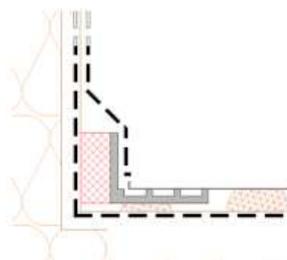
esempio di raccordo del davanzale alla spalletta con due superfici drenanti (lo strato 1 corrisponde al davanzale stesso, lo strato 2 all'impermeabilizzazione a forma di vasca sottostante)
